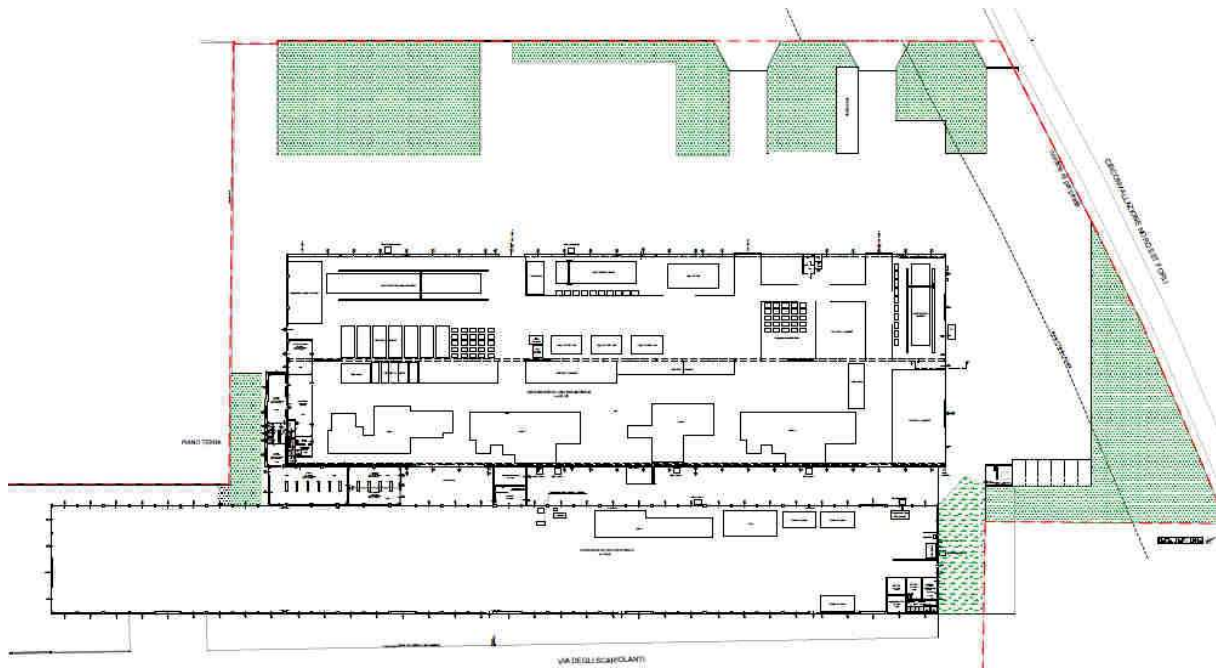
Planimetria generale a descrizione dello stato legittimo dei luoghi
